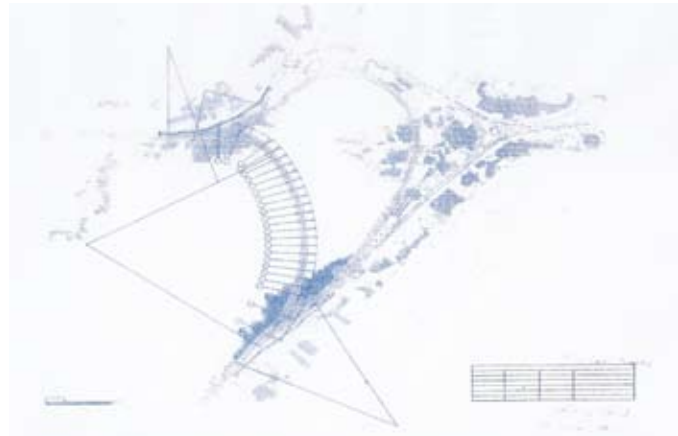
Vista en planta del desarrollo del puente, sobre la Laguna Bojórquez
